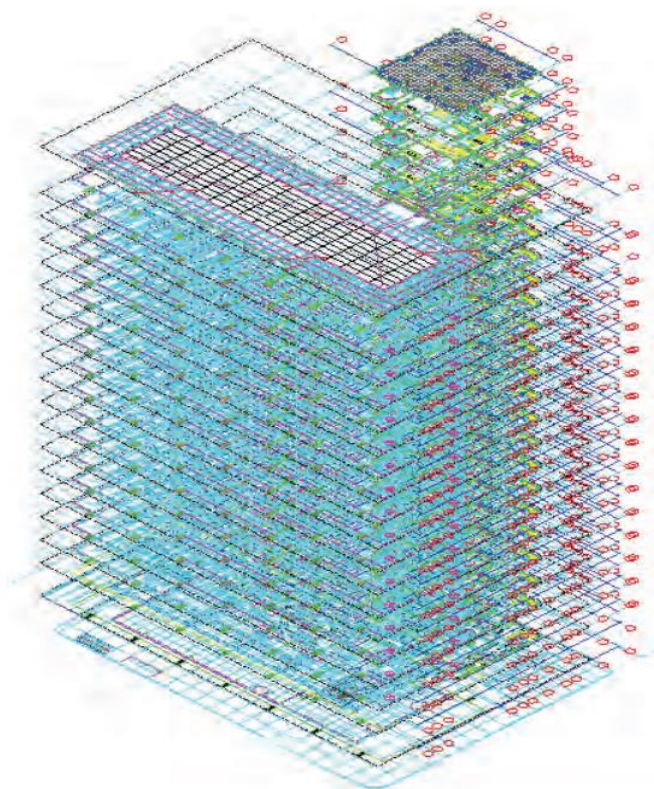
Utilisation des plan DAO Autocad pour générer la maquette BIM sur Revit.
